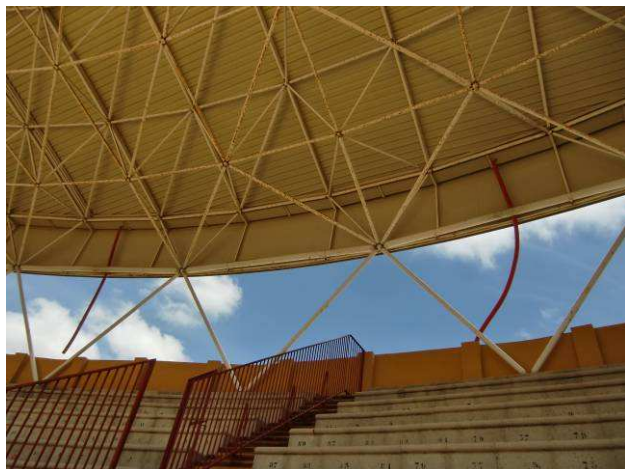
Oxidación de perfil tubular con pérdida de material de protección
